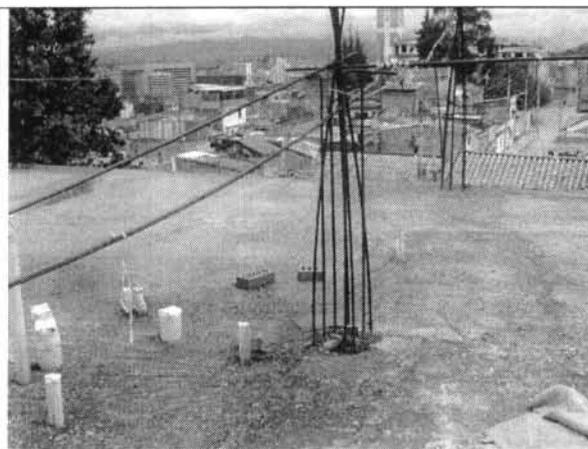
Vista placa superior parte posterior nueva, acero de prolongación de columnas.
